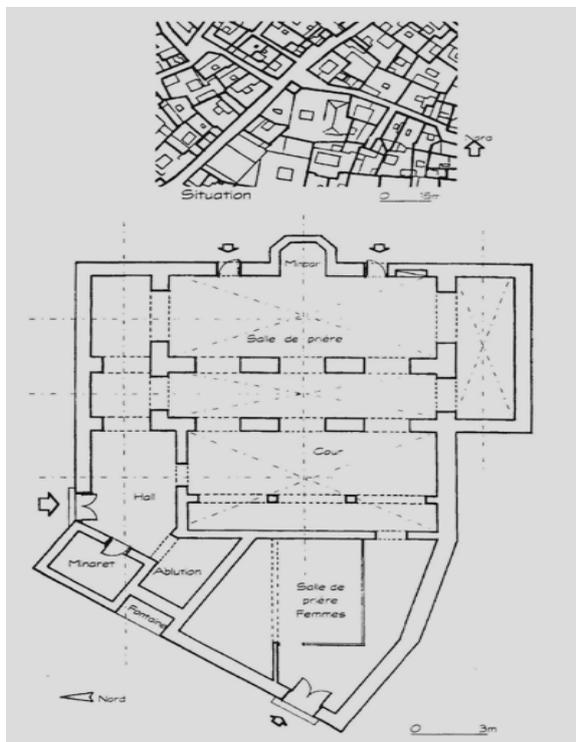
Städtebauliche Lage und Grundriss der Moschee El Baoukhir
